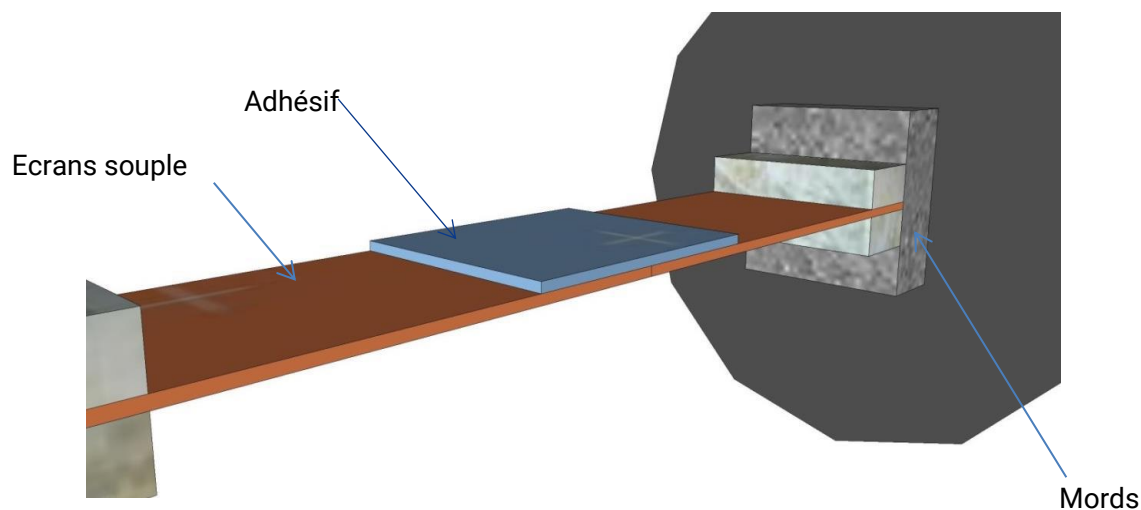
Essai de cisaillement sur un raccord de membrane avec un collage au ruban adhésif (visible)
